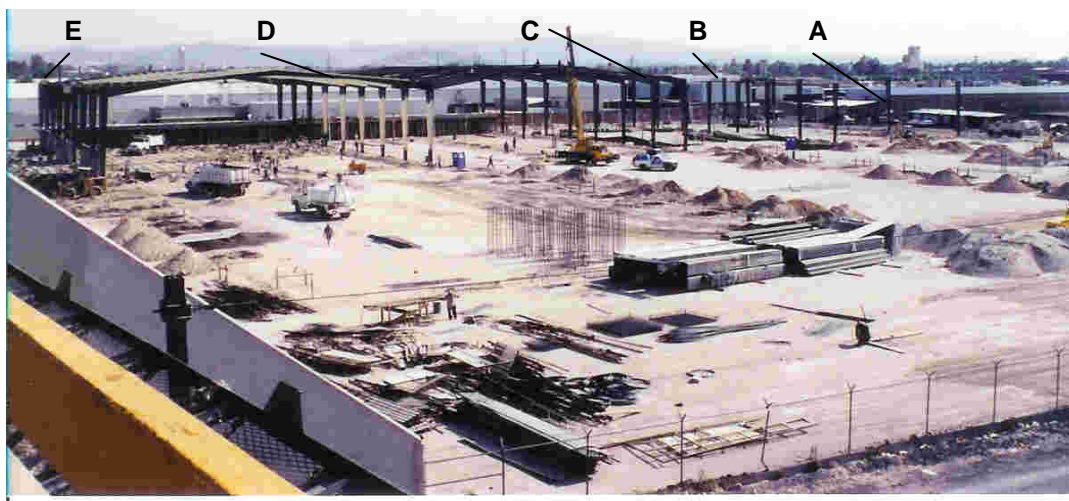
Terminación de montaje de traves MA-1 entre ejes C y D de 38 m, ver plano 2.3
